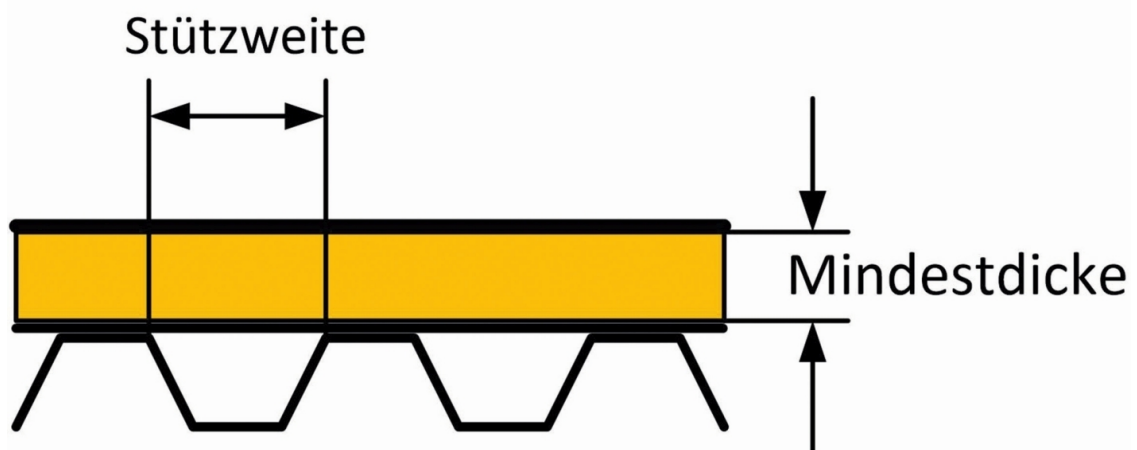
Minstdicken der Dämmschicht auf Stahltrapezprofilen (Quelle: Schmidt)
